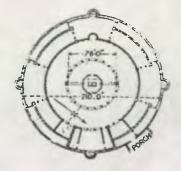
Planta de la Iglesia de San Stefano Rotondo.
